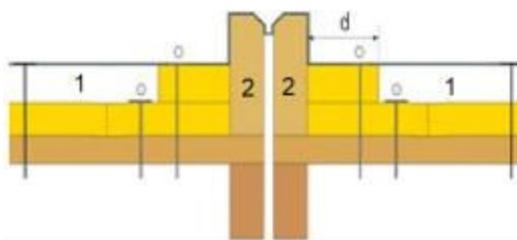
Exemple de traitement au droit d'un joint de dilatation sur élément porteur bois - panneaux à base de bois, reposant sur deux appuis transversaux continus
